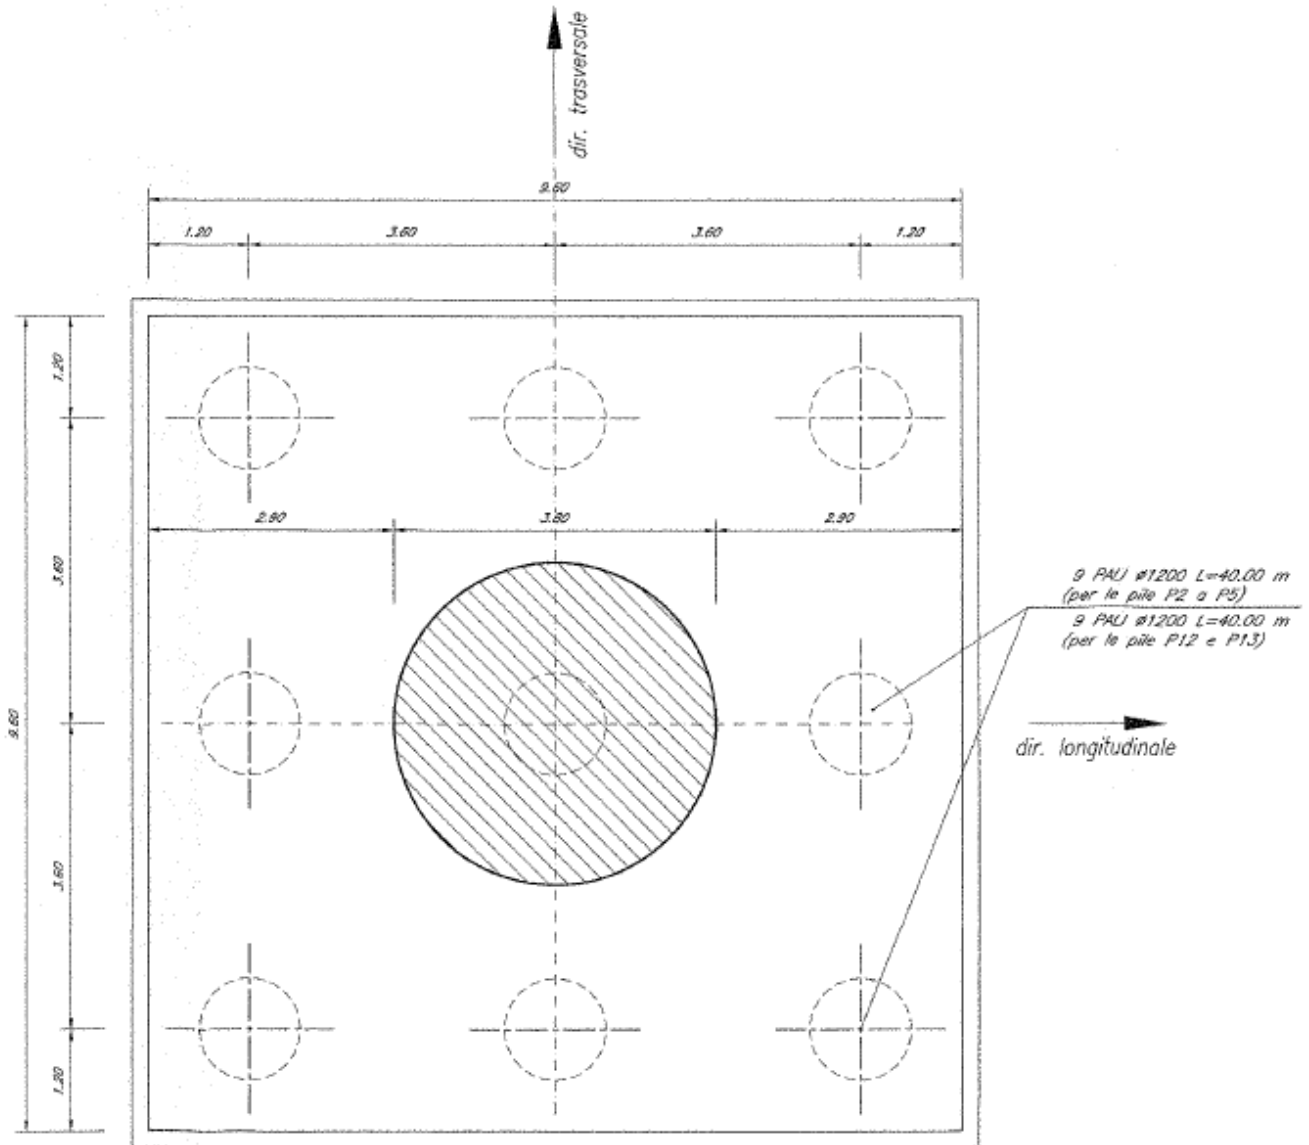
Plinto di fondazione e pali, vista in pianta - Sezione del fusto pile [m]
